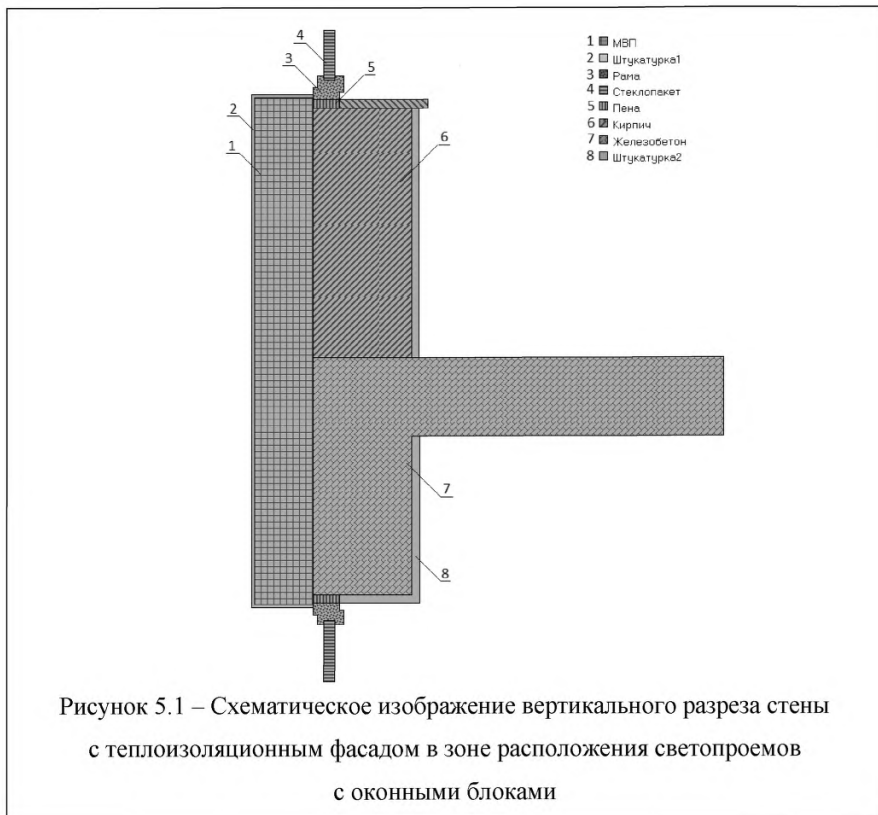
Схематическое изображение вертикального разреза стены с теплоизоляционным фасадом в зоне расположения светопроемов с оконными блоками
